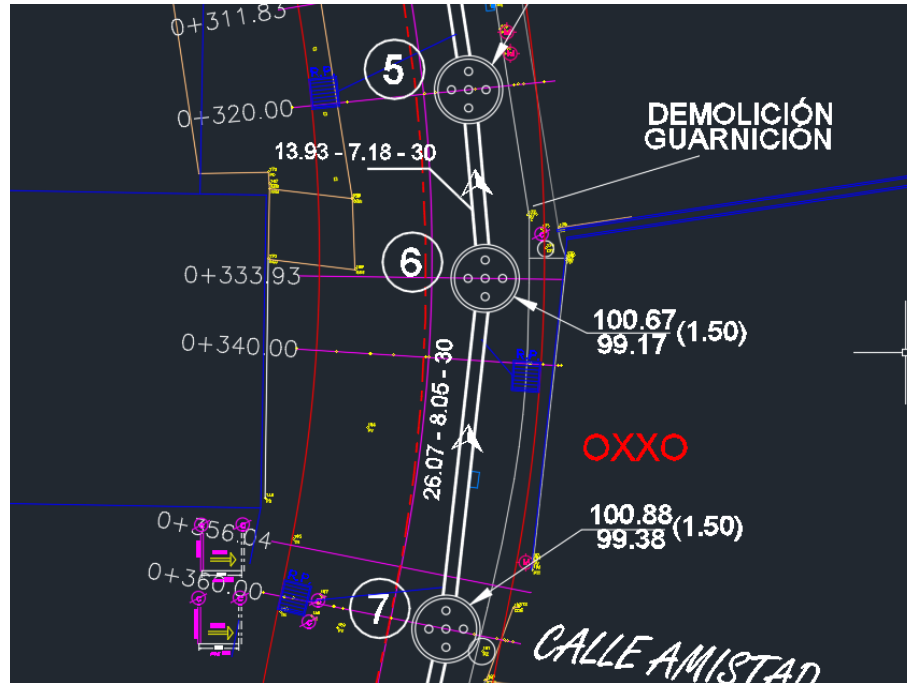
Fragmento del plano de drenaje pluvial y rejillas pluviales. Fuente: (Departamento de proyectos de obra pública.)
